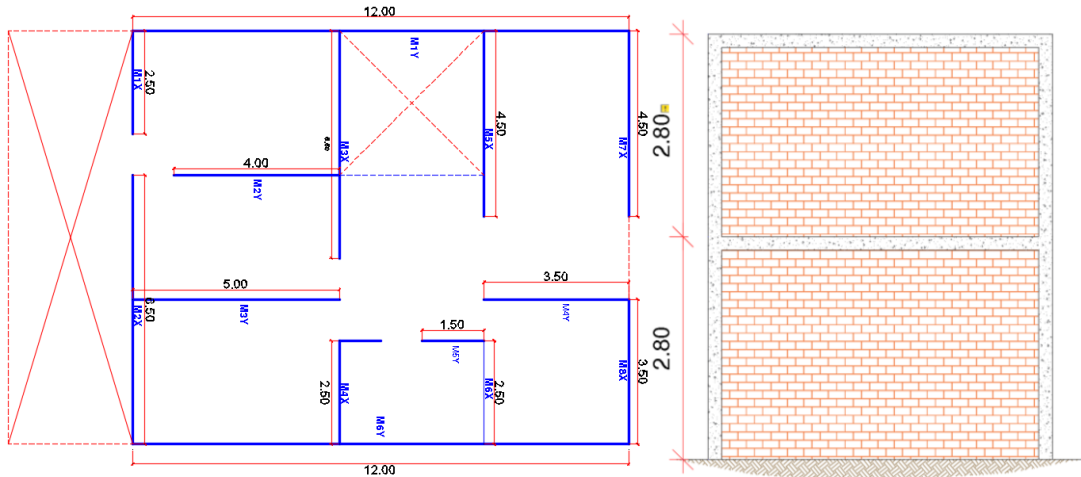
Levantamiento de la edificación analizada 1, plano utilizado para el estudio CH-70
